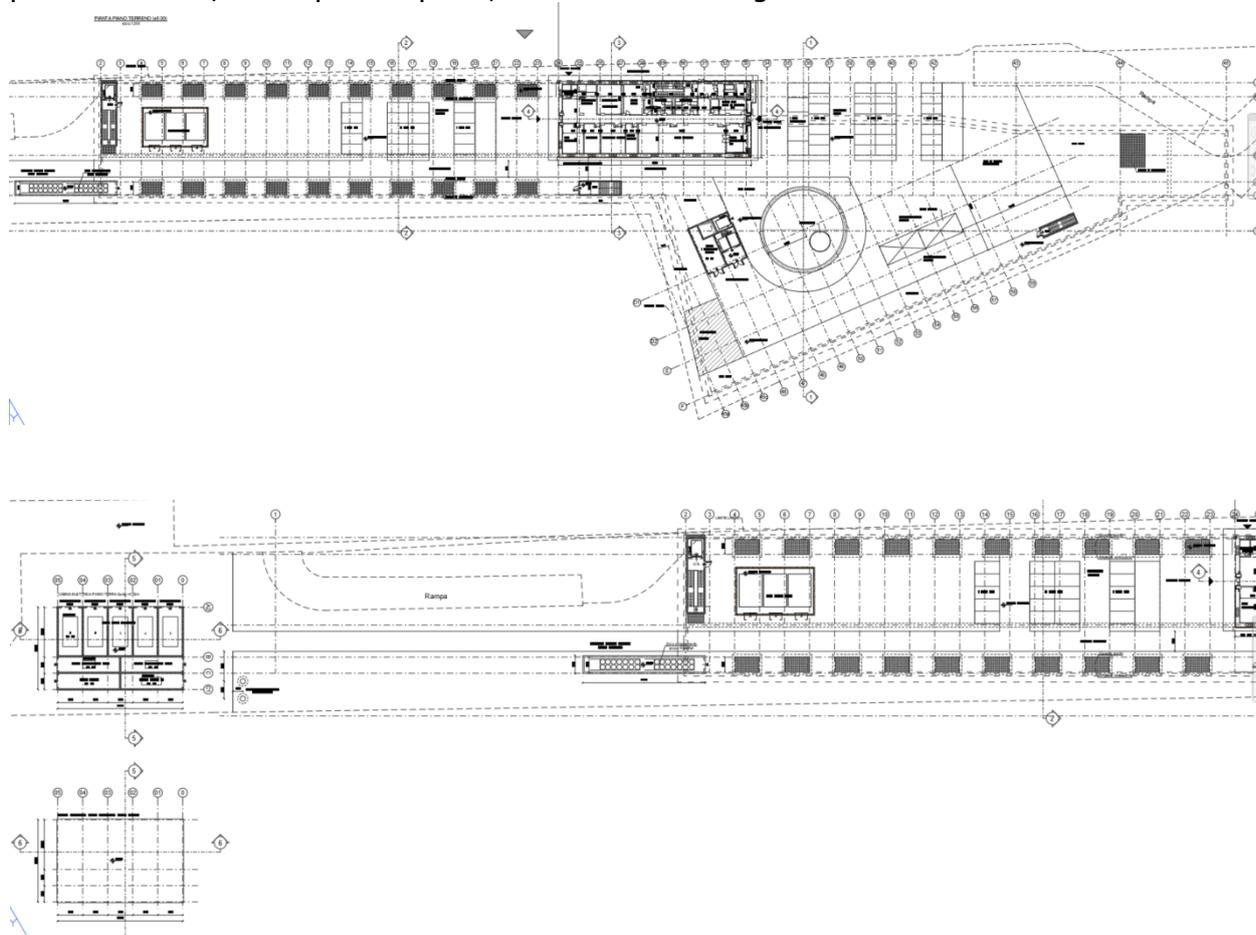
Inquadramento planimetrico dell'opera: Pianta Livello 0
